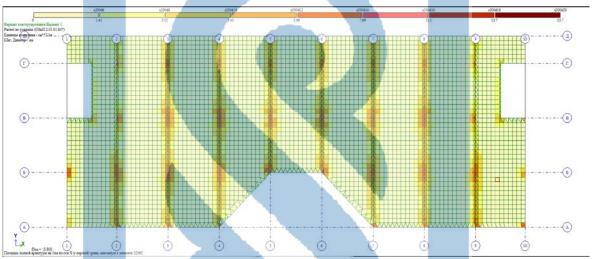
Конструирование плиты перекрытия по верхней грани по направлении X2
